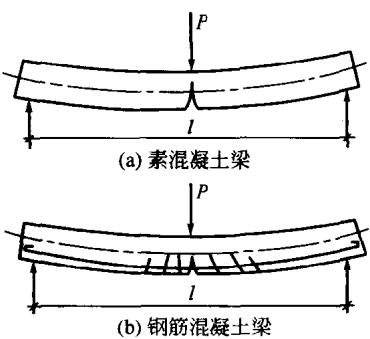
素混凝土梁和钢筋混凝土梁的破坏情况
